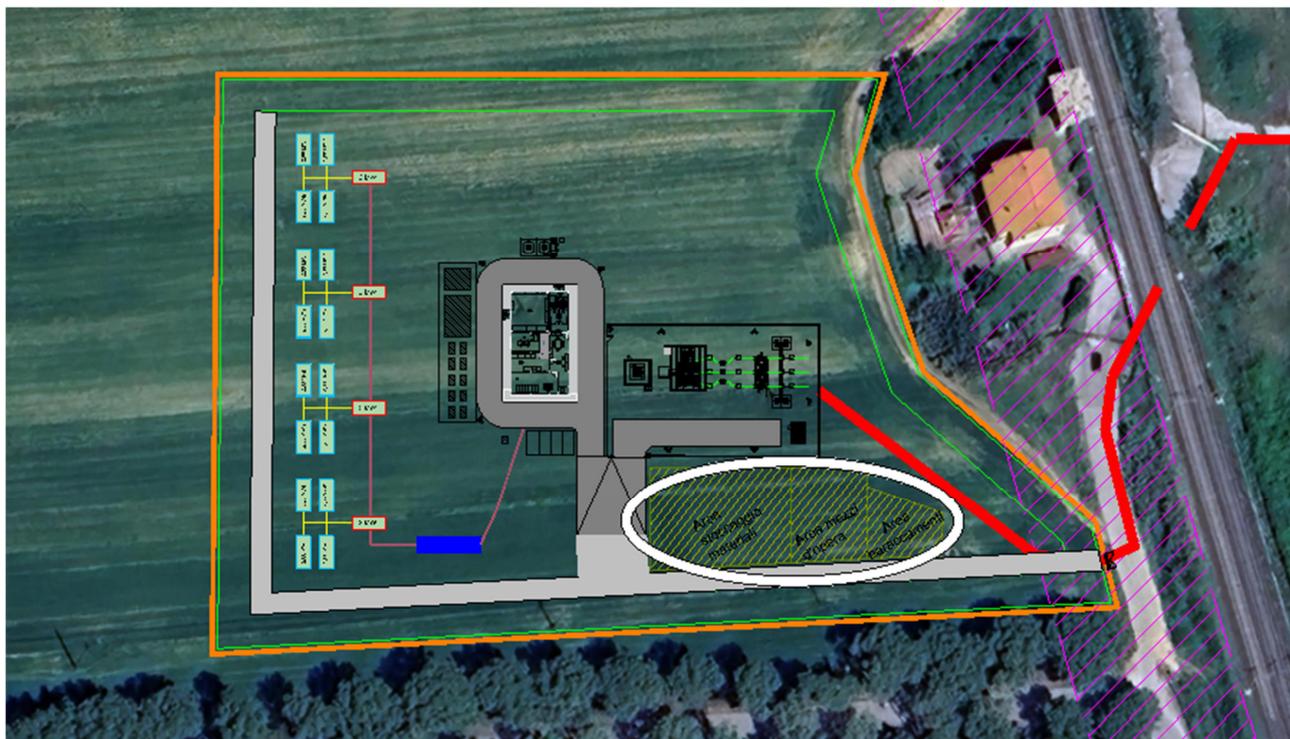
Planimetria con ubicazione delle aree tecniche di cantiere per l'impianto BESS
